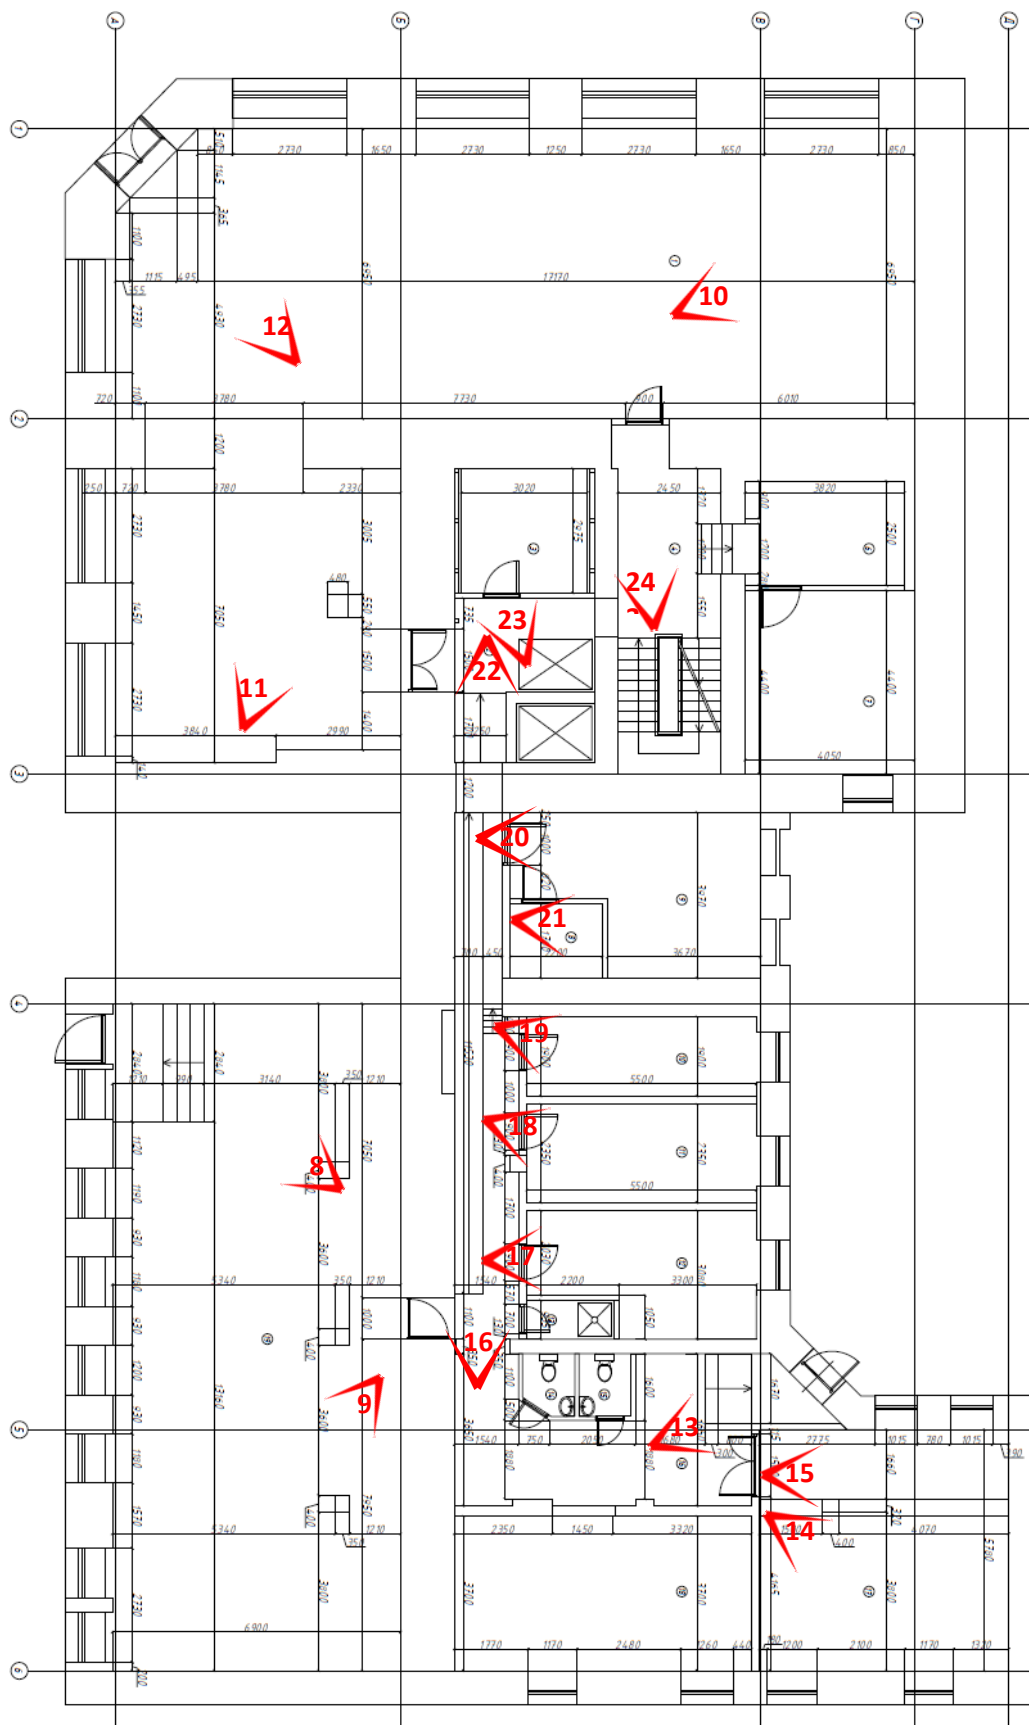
Схема фотофиксации на фрагменте плана 1 этажа
